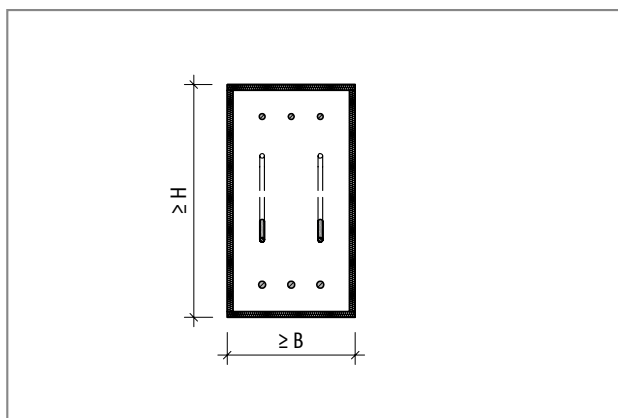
Schöck Isokorb® tip S: konstrukcija balkona z nepodprtimi spodnjimi vezmi
